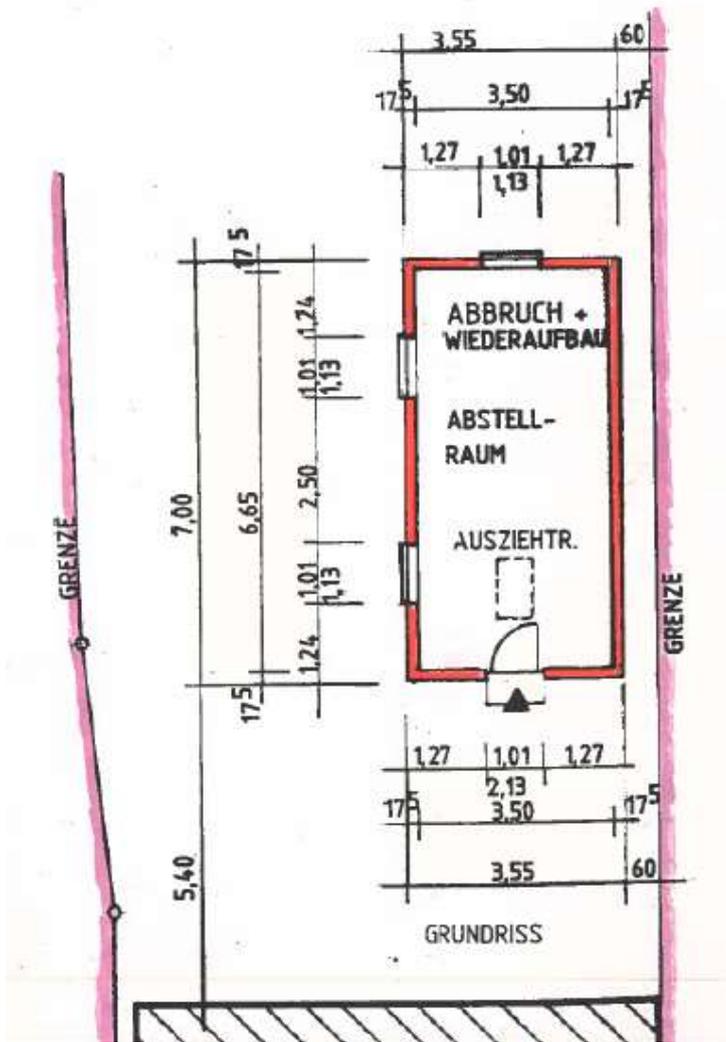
Grundriss und Schnitt; Quelle: Bauakte, Baugesuch zum Abbruch und Neubau eines Abstellgebäudes
